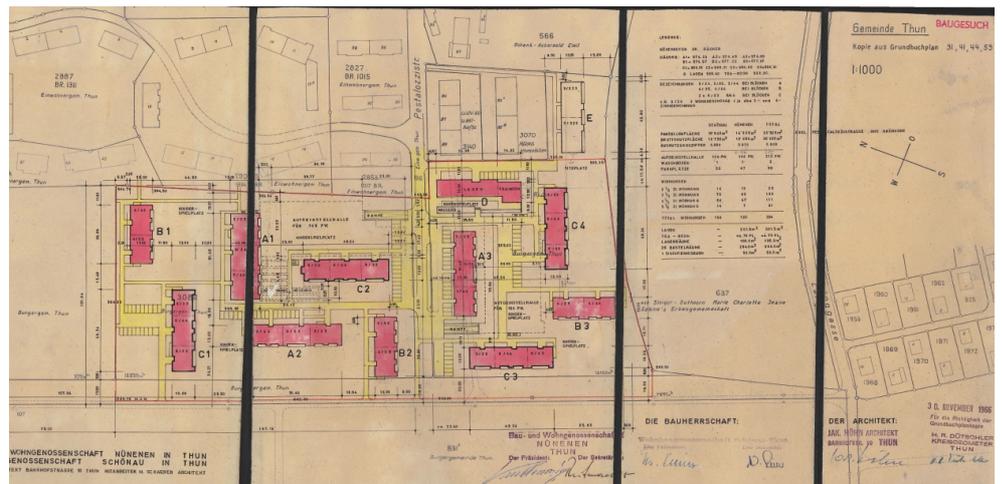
Bebauungsplan «Bürgerallee» (ohne Masstab)
